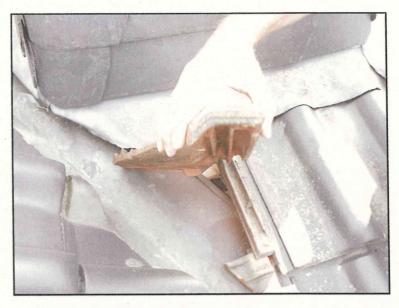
Vordach ohne Klammerung zur Wirbelschleppensicherung
